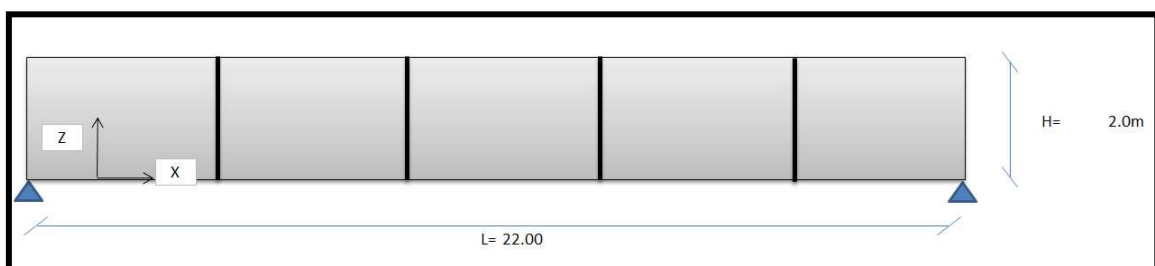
Geometría longitudinal de la viga principal, luego de pre dimensionamiento.
